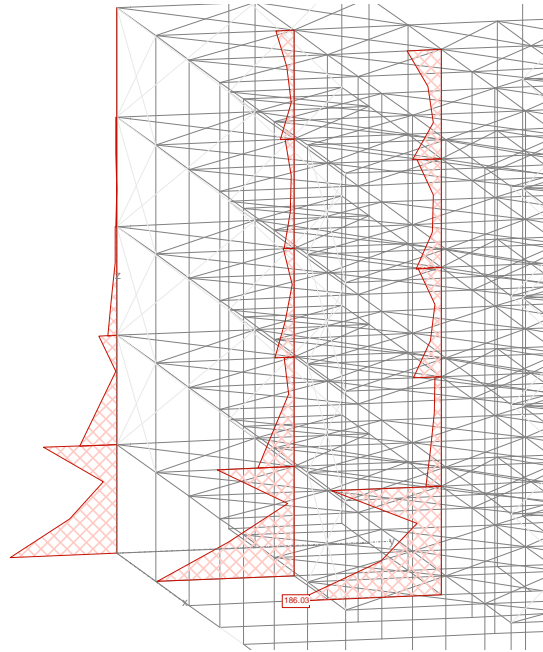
Distribución de momentos flectores en pilares en un edificio con planta diáfana.
